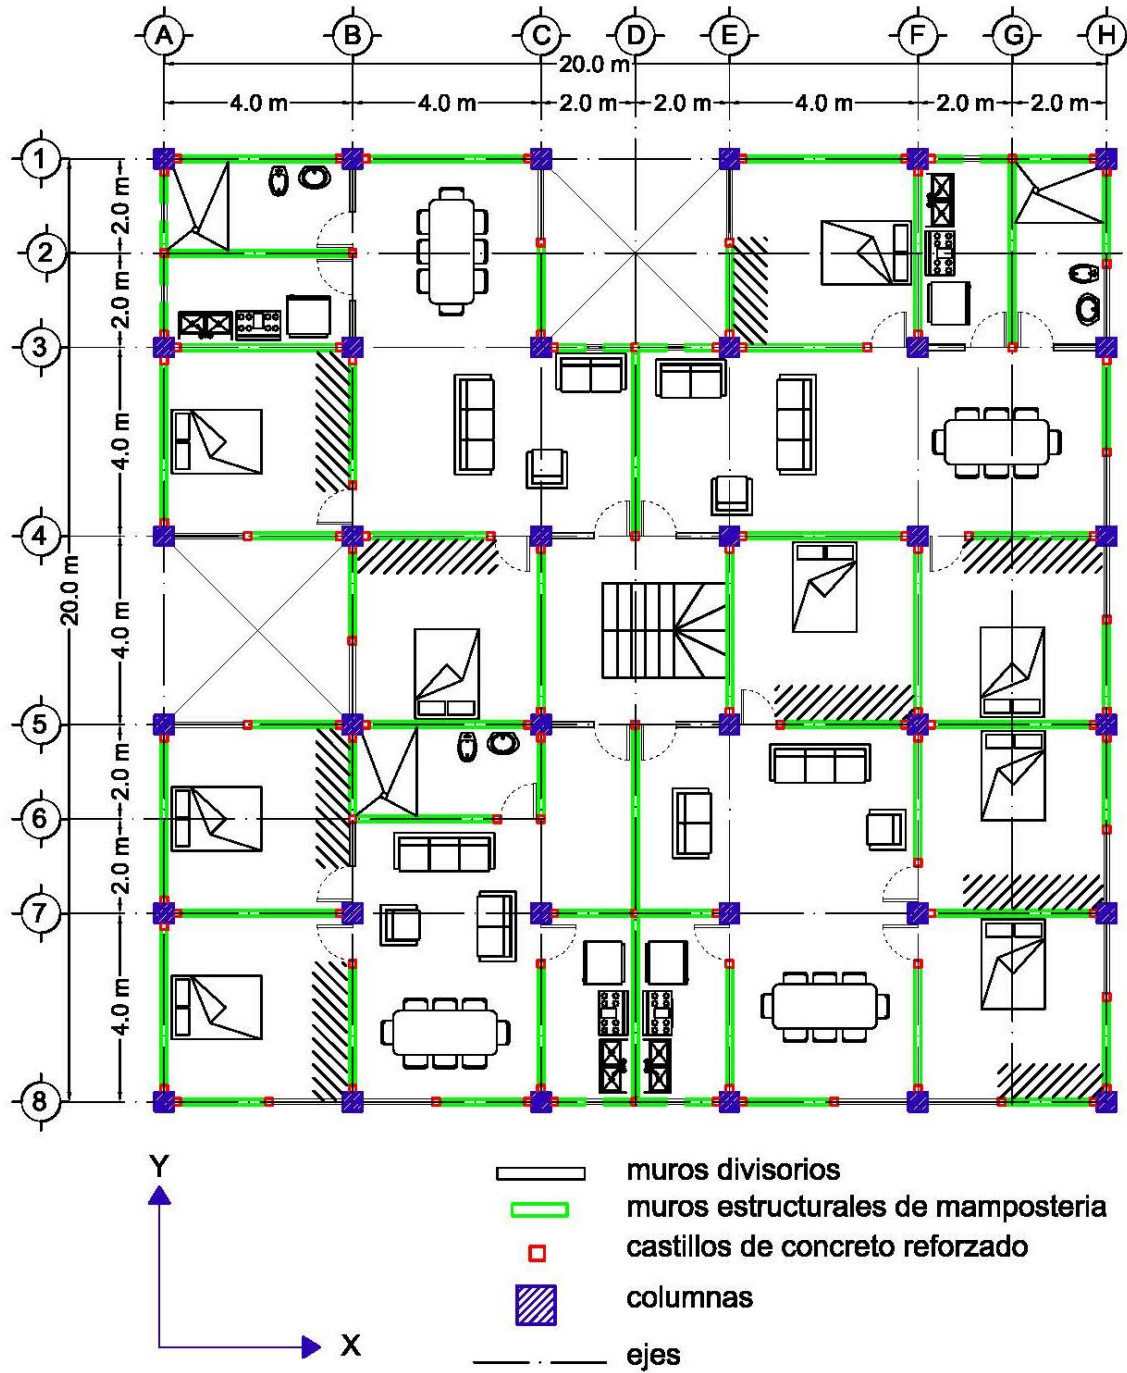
Planta arquitectónica de la planta baja, modelo M1.
